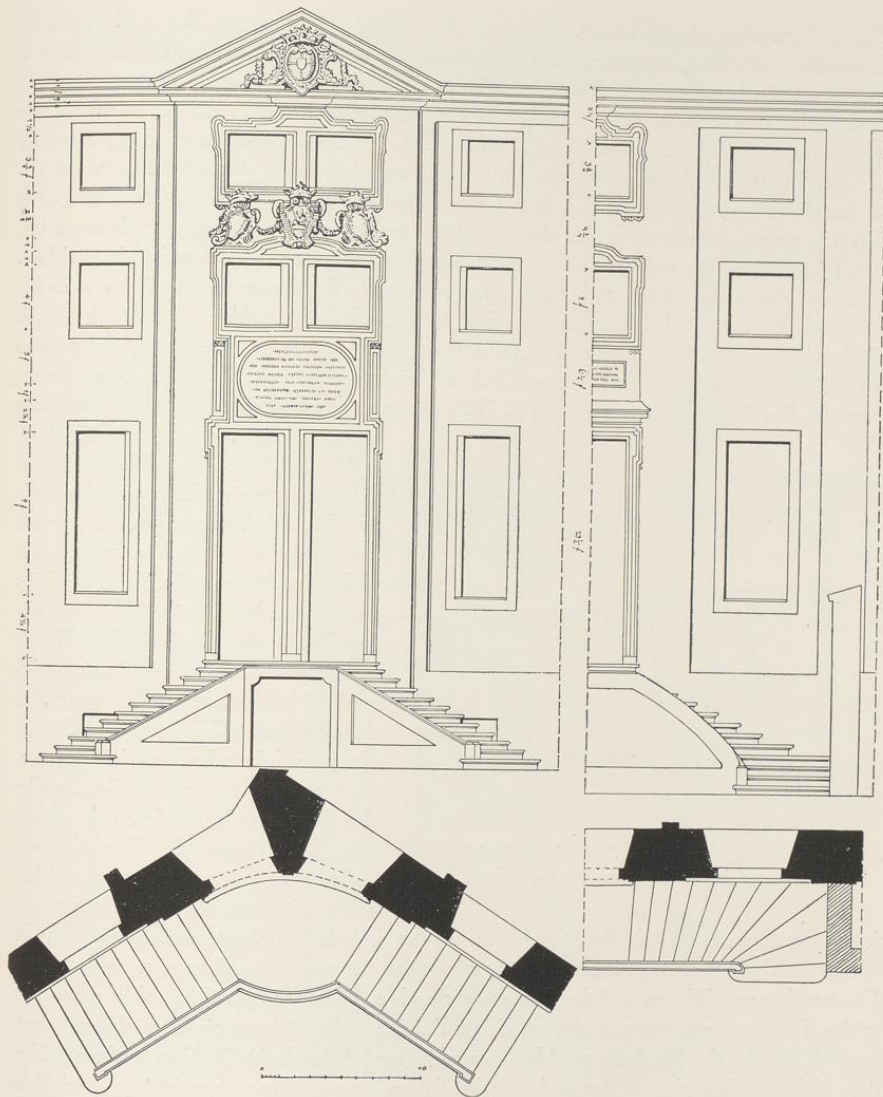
Grundrisse des Mittelrisalits und der Hälfte der Westfront im ersten Geschoß mit den entsprechenden Aufrissen. Zeichnung von J. C. Schlaun Nr. 733, Pause
